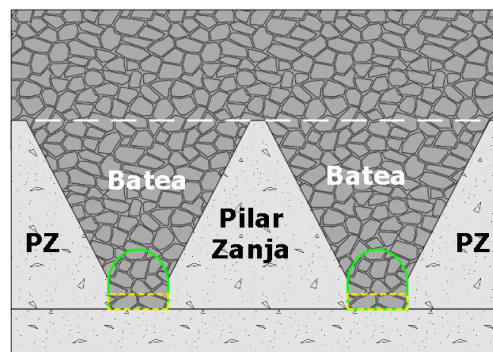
Perfil B-B' de pilares zanja, modificado de Arce, 2002
